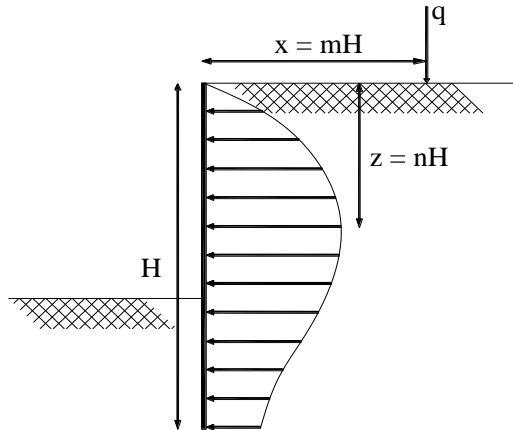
5 Tekanan Tanah Akibat Gaya Merata (*Design Of Sheet Pile Walls*)
